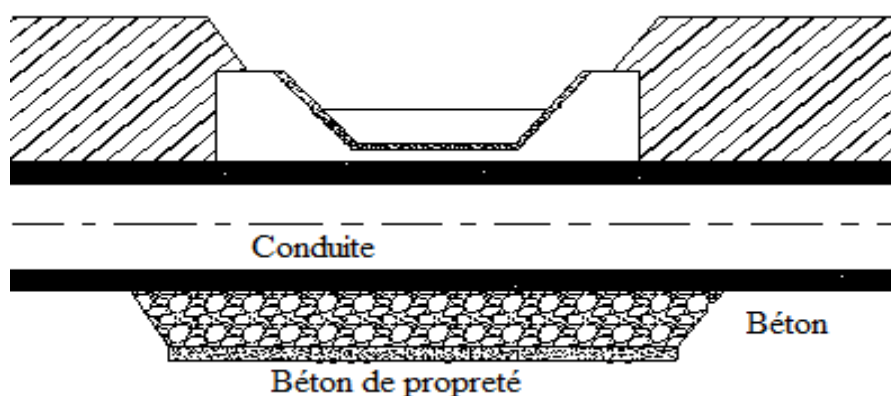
Traversée d'une rivière ou d'un Oued
